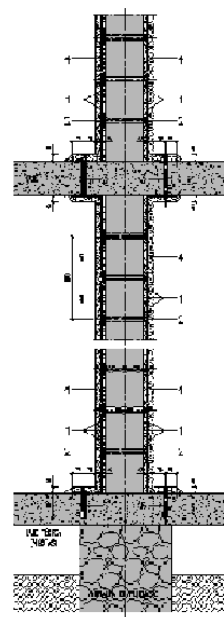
Pormenor tipo de reforço de paredes em alvenaria de blocos de betão.
